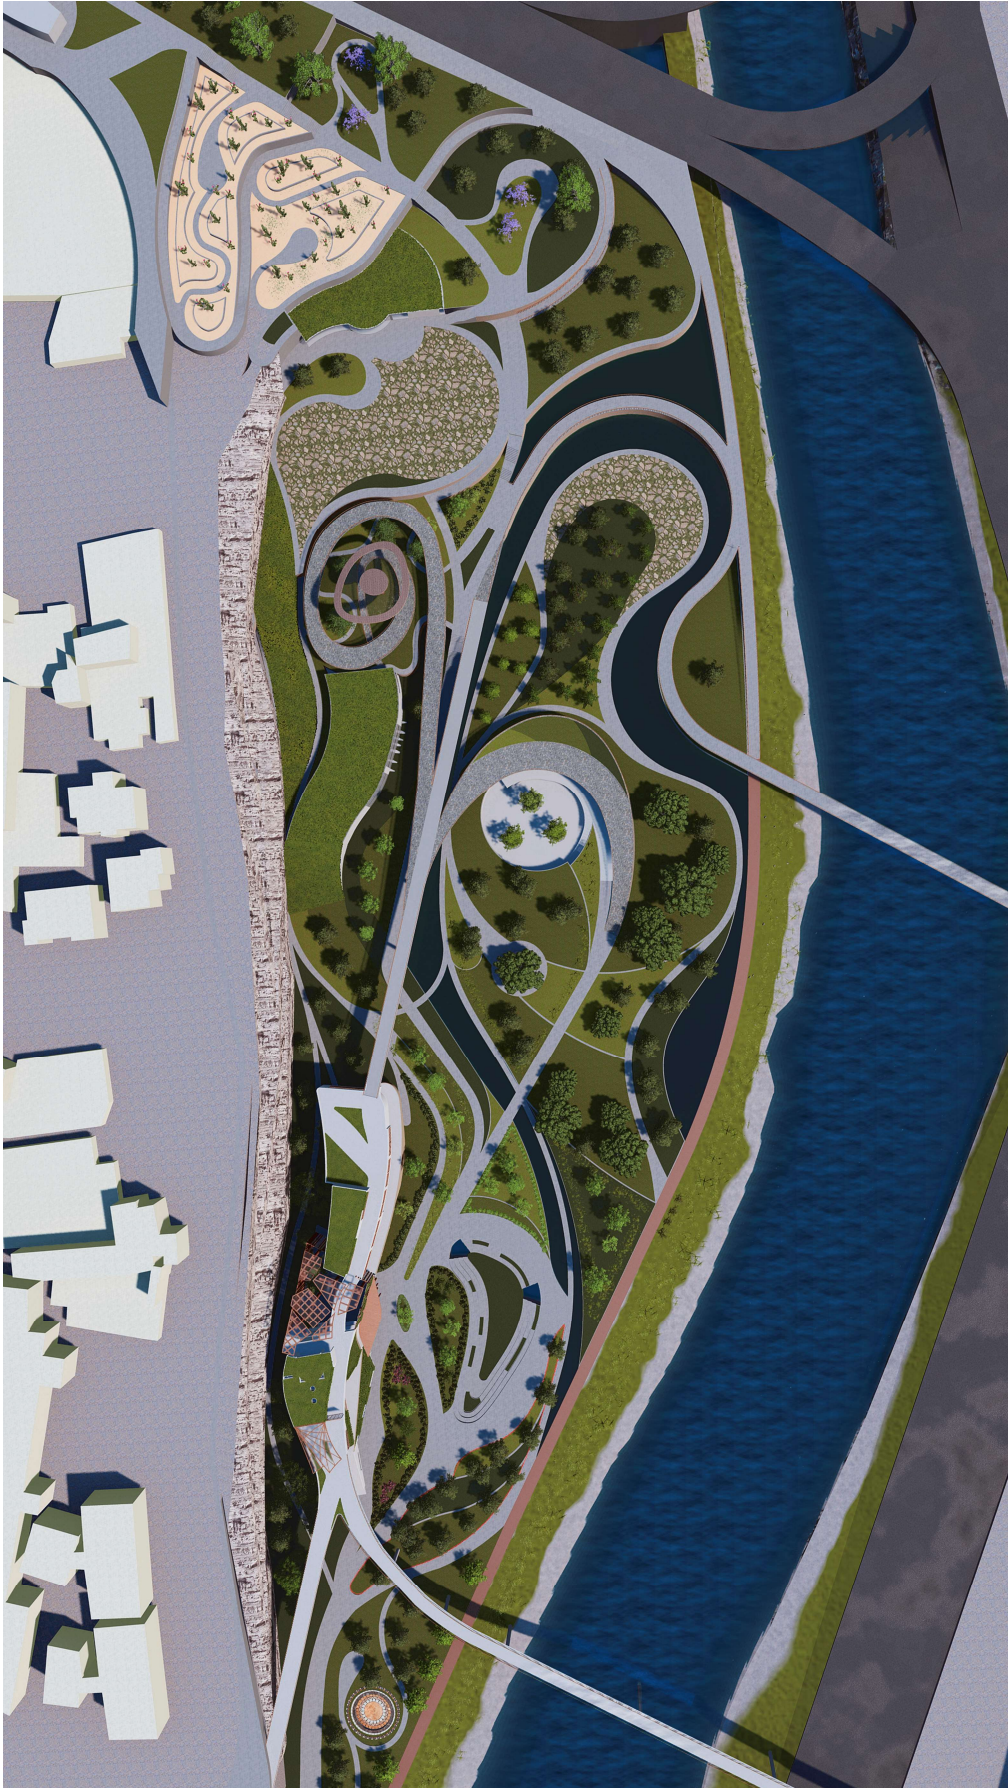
Vista Planimetría - Jardín Botánico Río Chill
